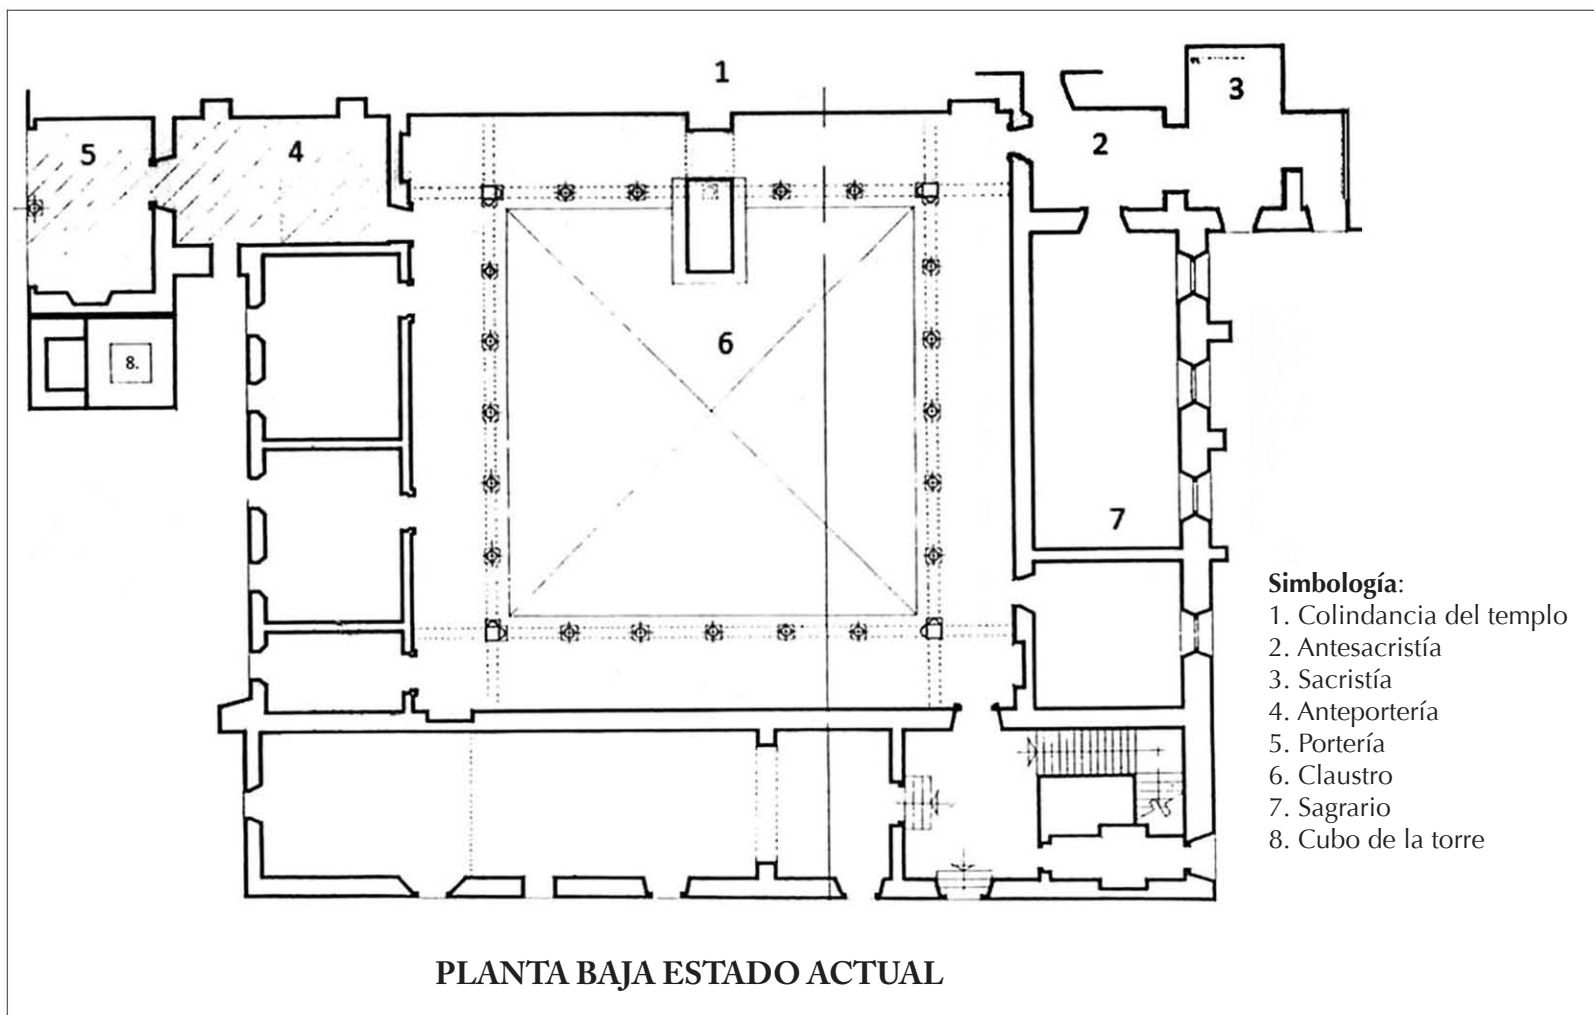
Levantamiento, planta baja del estado actual. Archivo geográfico, INAH, CNMH; *San Bernardino de Siena, templo y ex convento*, Col. Santa Cruzita Barrio, Delegación Xochimilco, DF, Planoteca.
